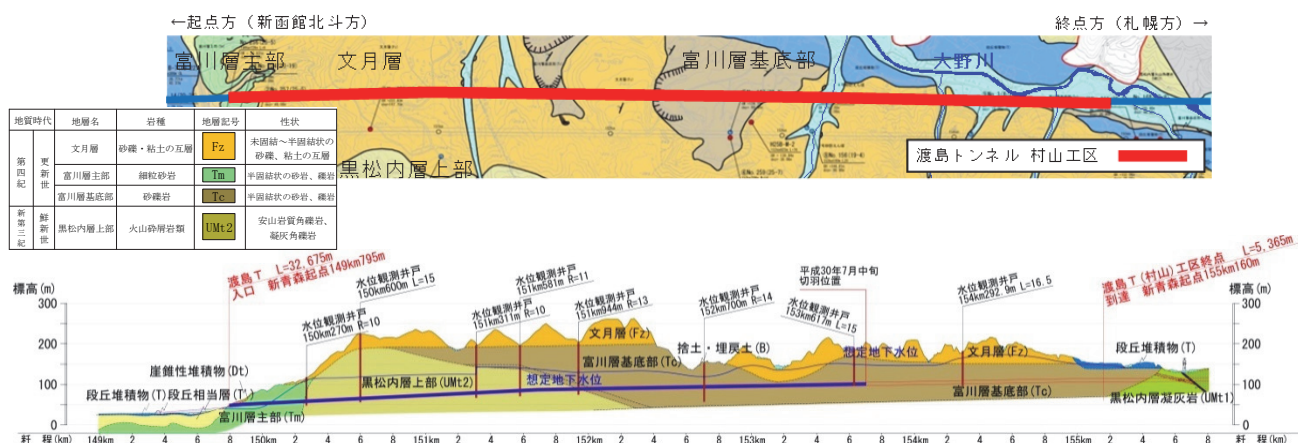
渡島トンネル（村山工区）地質平面図・縦断面図
